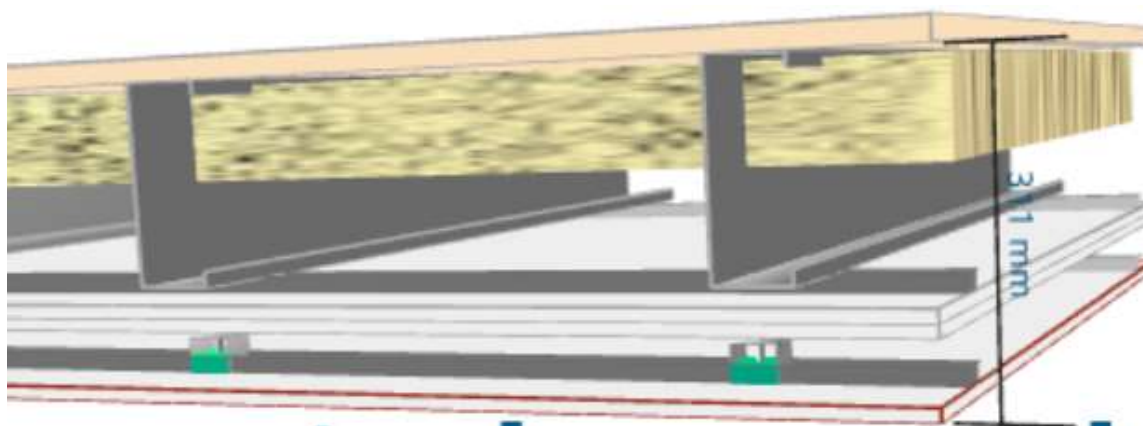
Exemple de plafond à poutres en C avec double lame d'air
